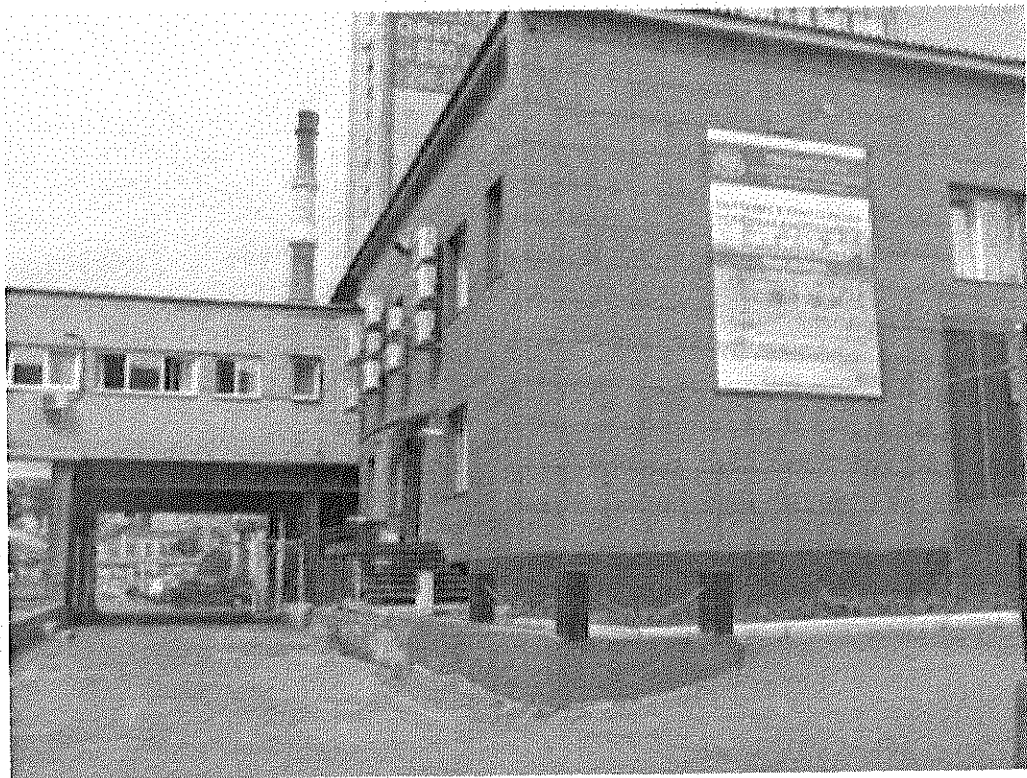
Фасад здания в осях А/6-7. Пристроенное 2х этажное строение.
